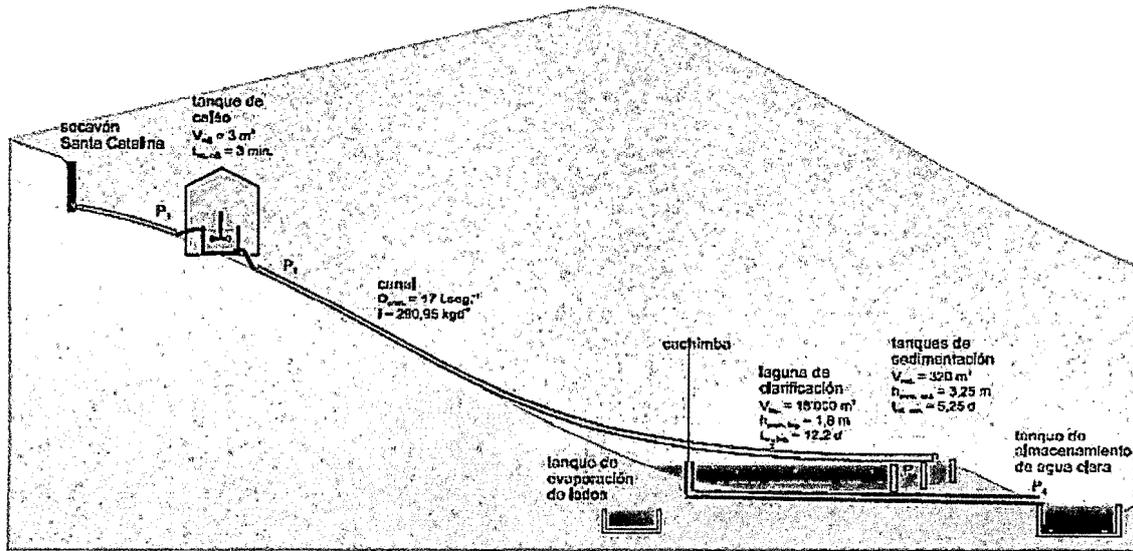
Planta de Tratamiento Kumurana - La Lava - Bolivia
